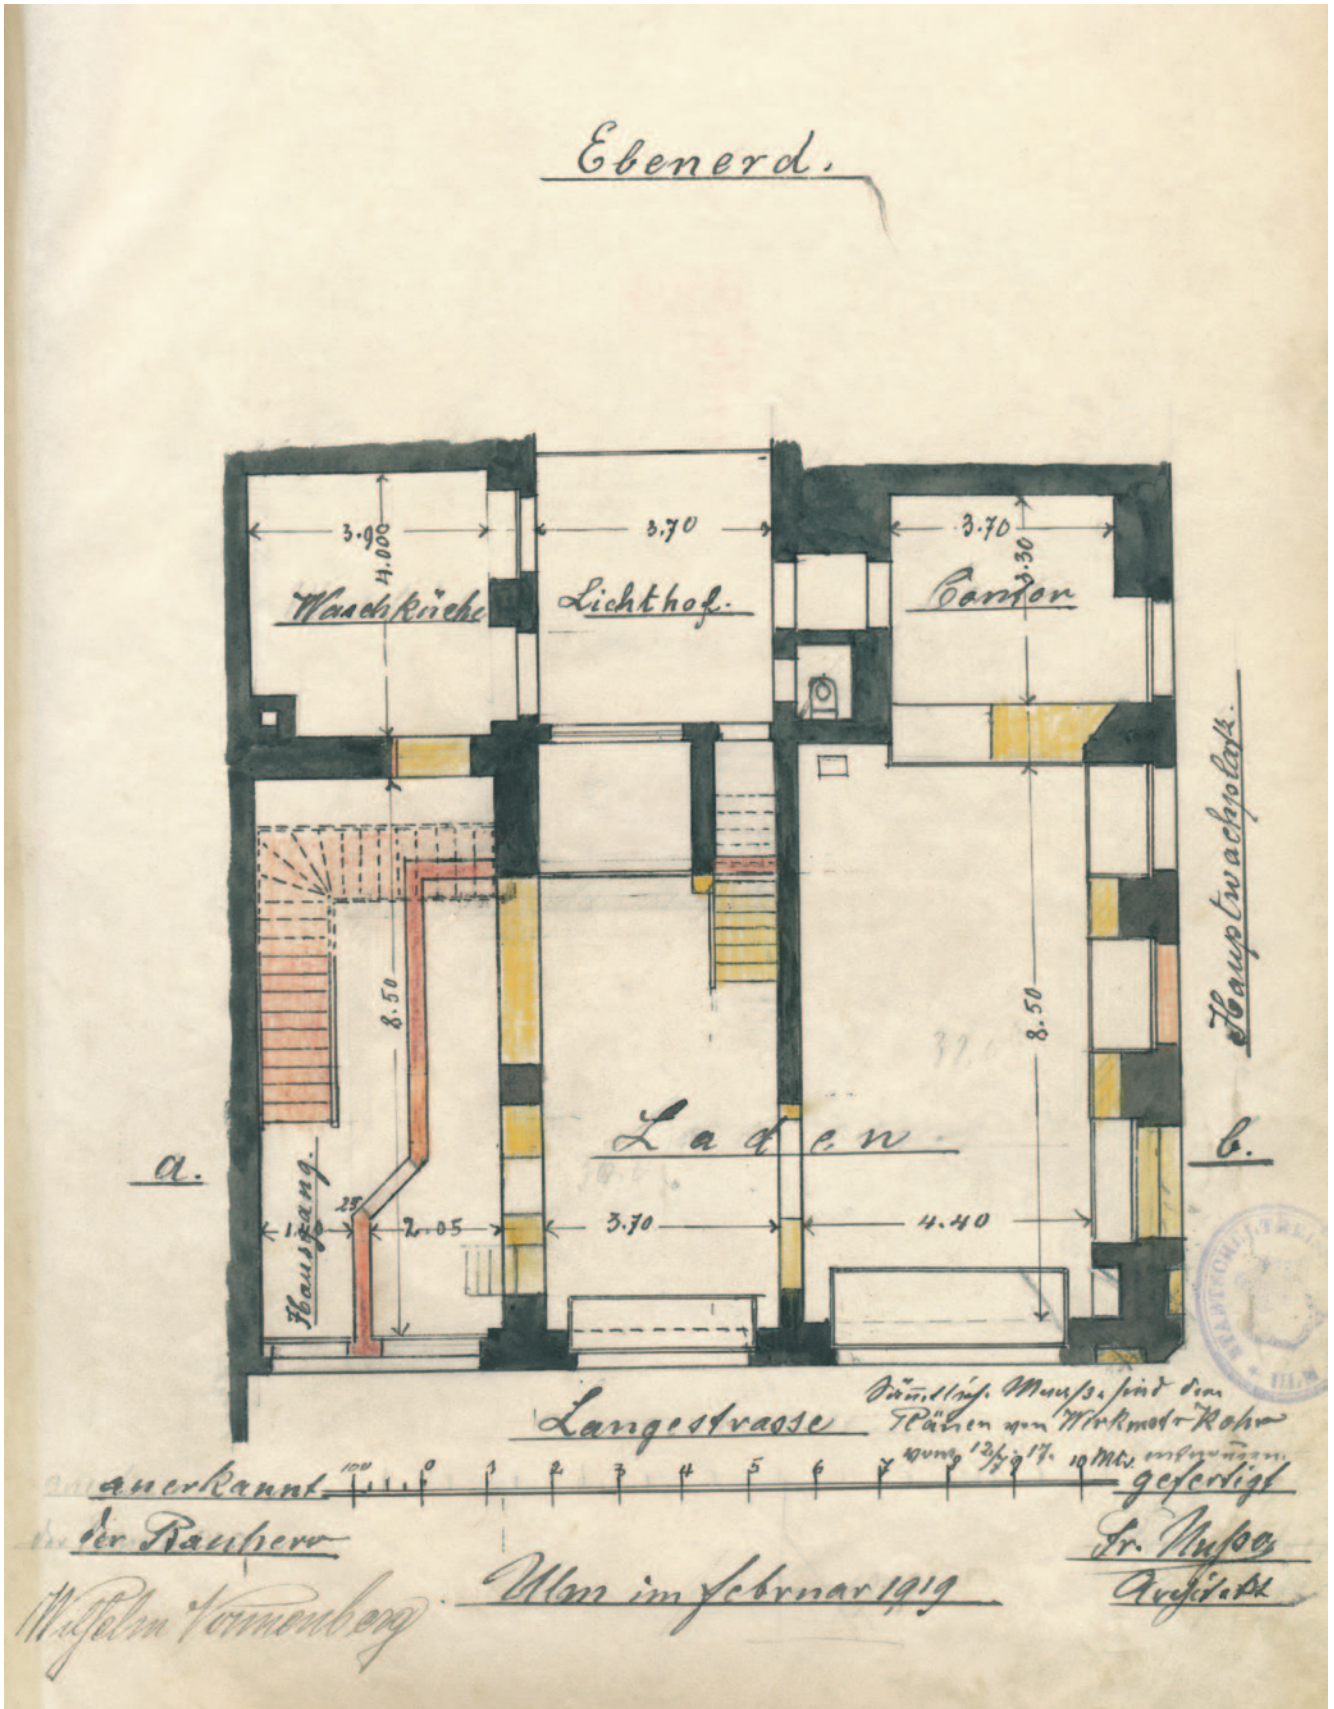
Gebäude Lange Straße 8 (A 185), Erdgeschossgrundriss, Baugesuch 1919.
